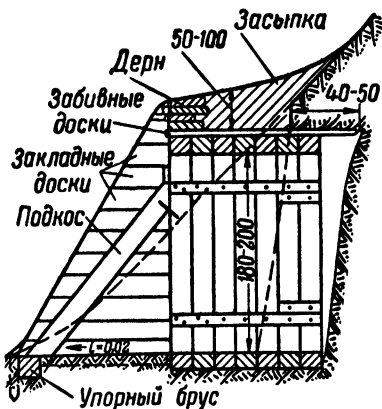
Оголовок горизонтального входа при угле наклона местности свыше 30° в слабых грунтах
